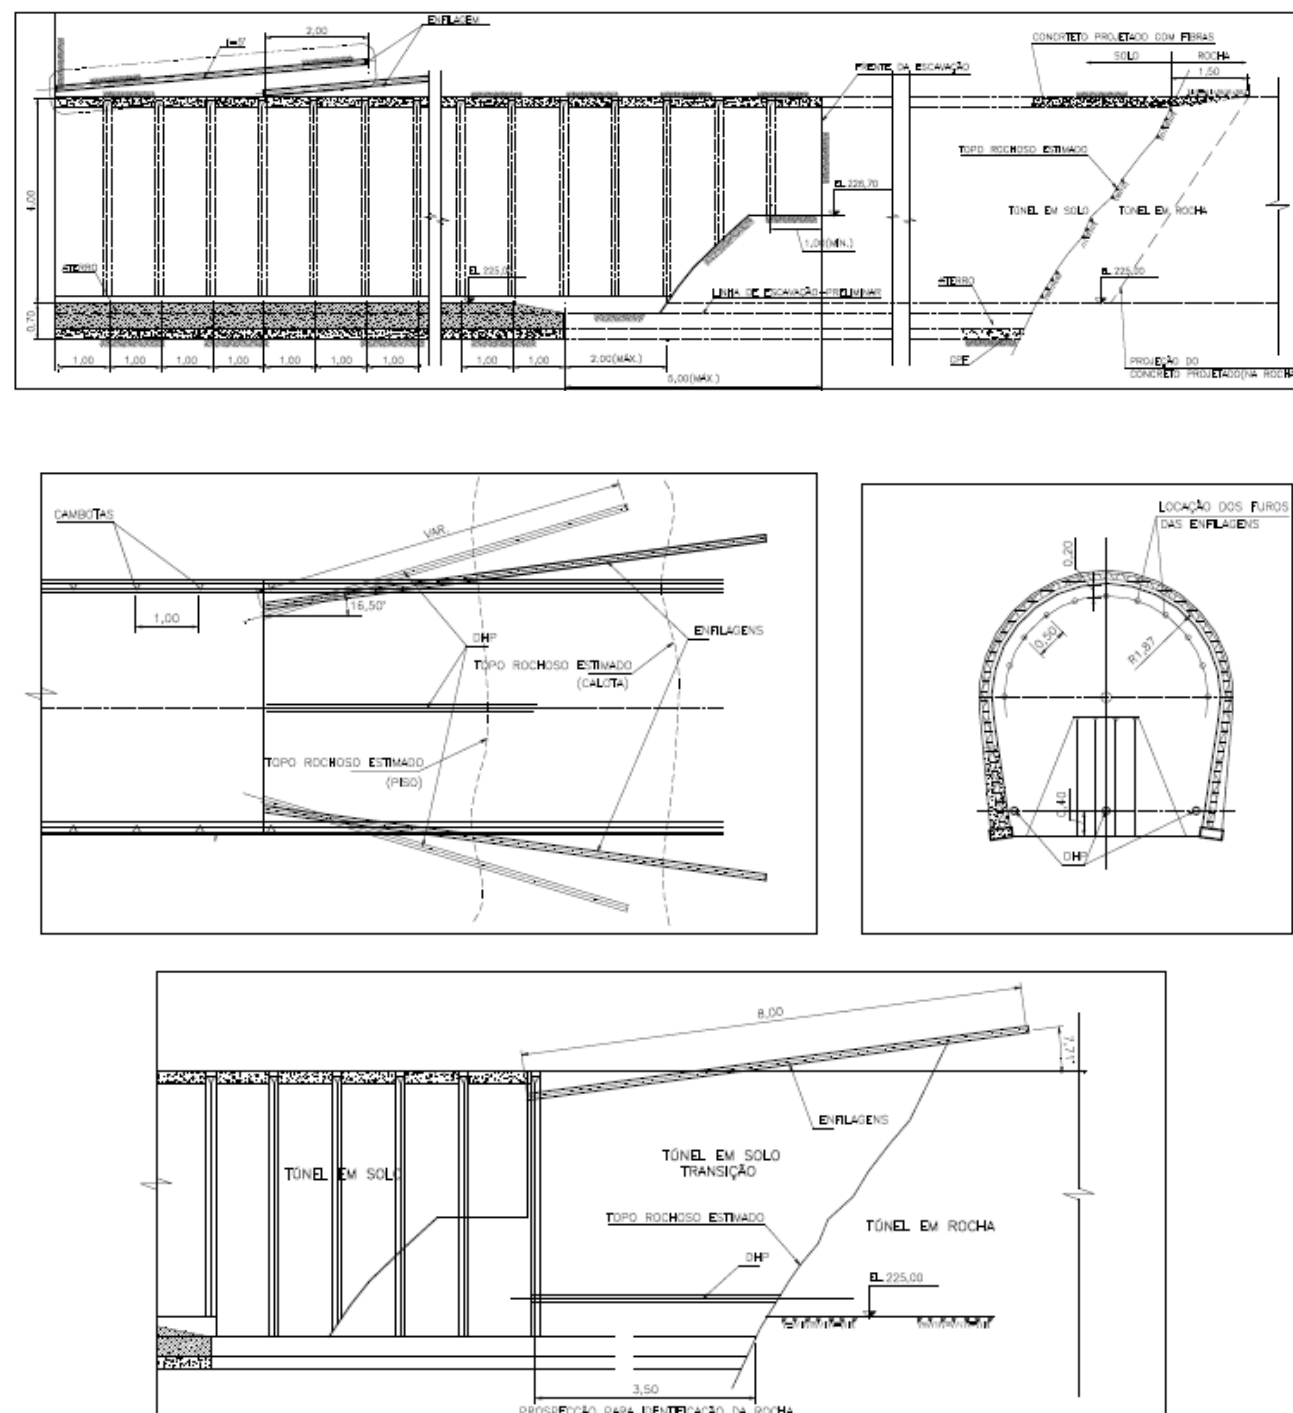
Desenho esquemático do avanço da escavação com enfilagem das cambotas e concreto projetado
